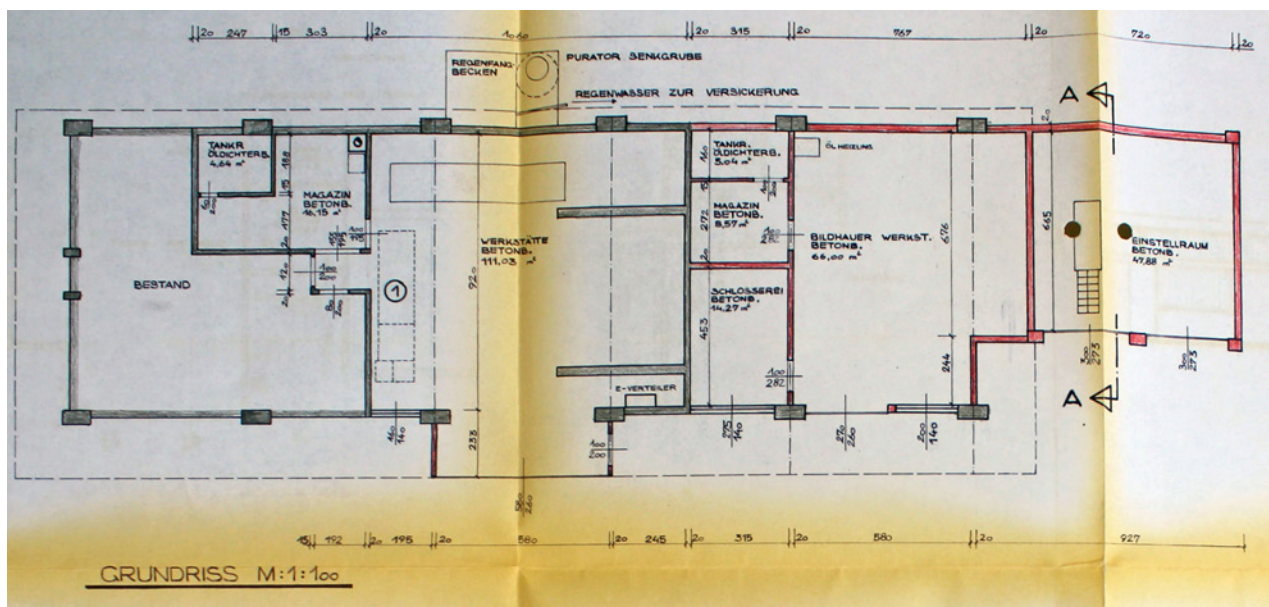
Grundriss Zu- und Umbau, 17.12.1990
